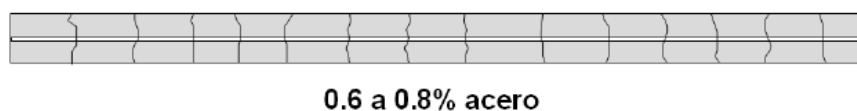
Pavimentos de concreto continuamente reforzado.
